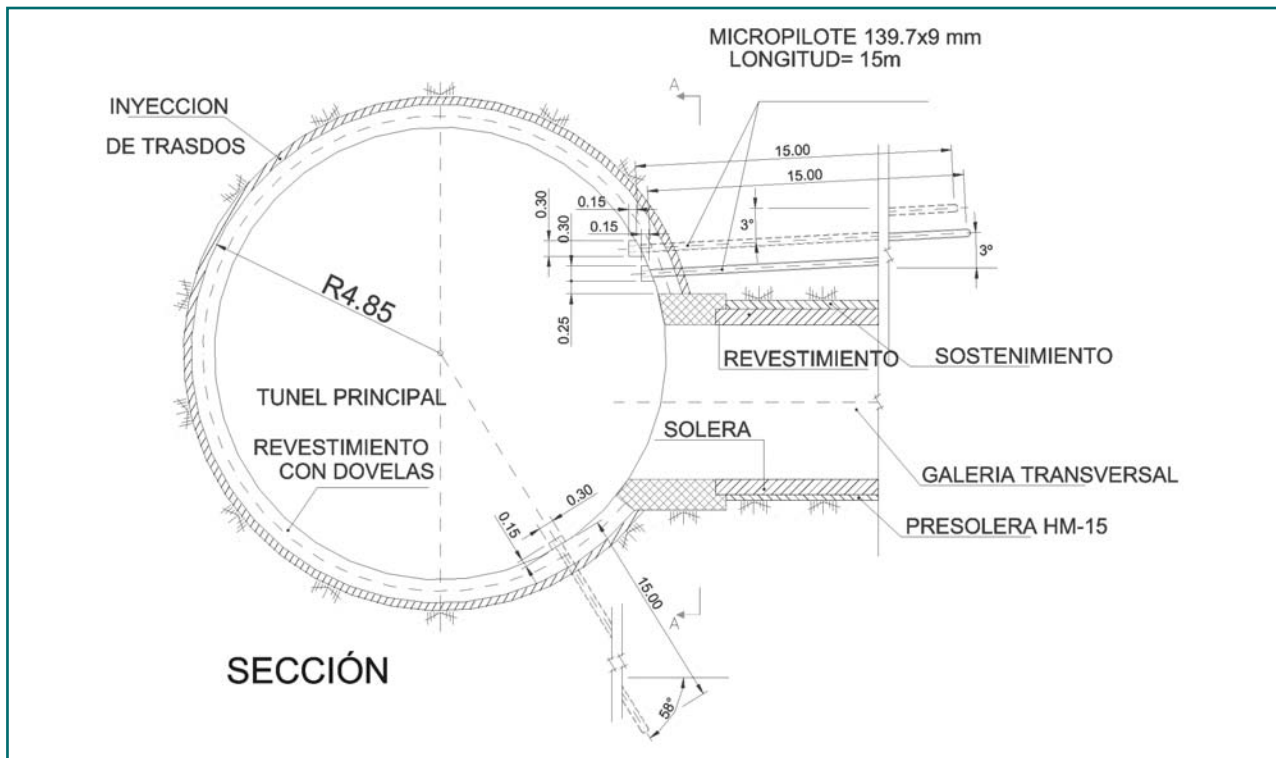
Sección tipo de la conexión entre túnel principal y galería transversal/ Standard section of junction between main tunnel and connecting gallery.
